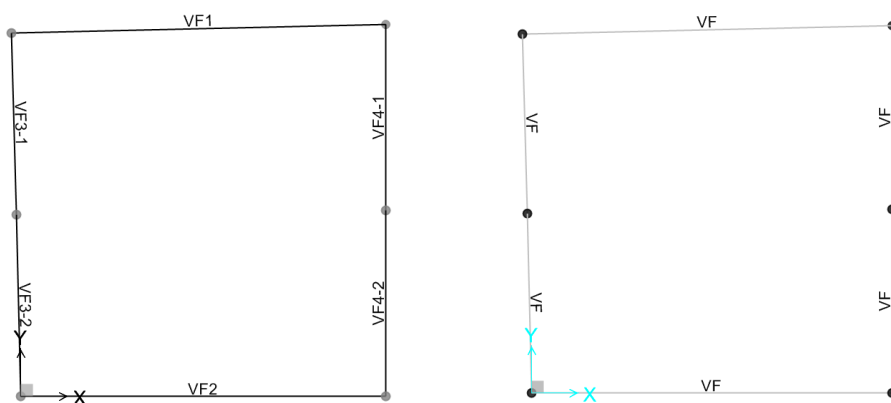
Numeração e secções das vigas de fundação do piso 0 (VF1 a VF4)
